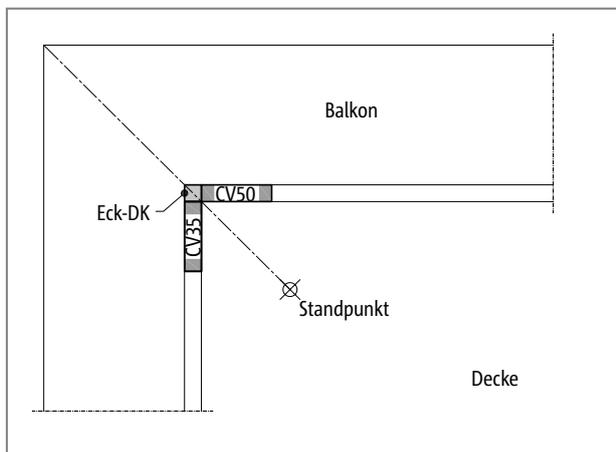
Schöck Isokorb® Typ EXT: Betondeckung wählbar: Hier CV35 links vom Standpunkt, Betondeckung CV50 rechts vom Standpunkt
